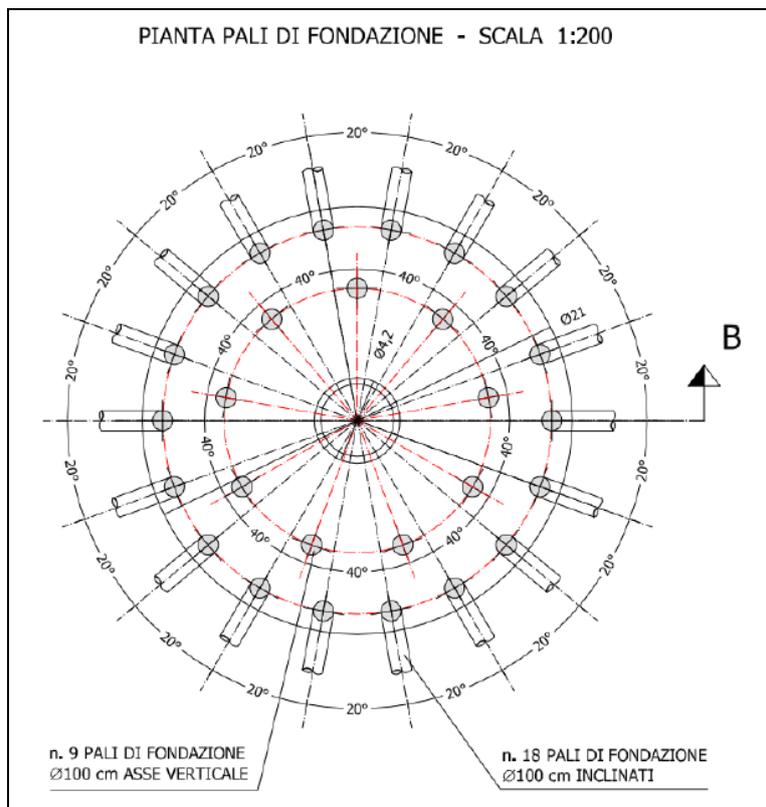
Schema strutturale delle fondazioni profonde – pianta piastra circolare e pali (da GEO s.r.l., Relazione Tecnica Descrittiva).
